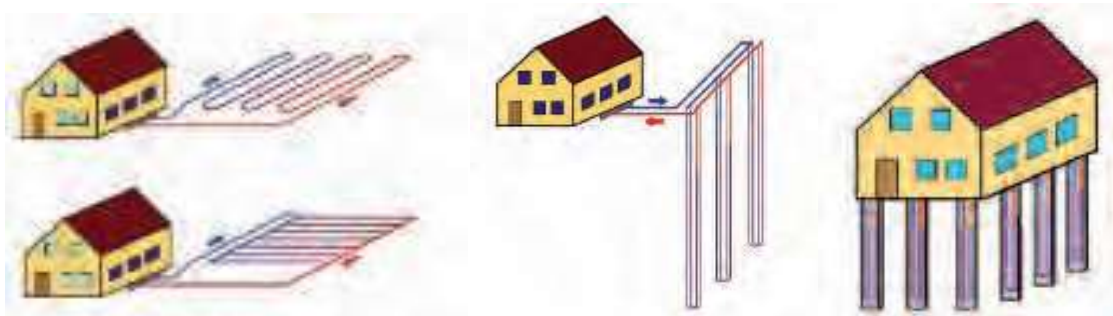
Captación Horizontal, Vertical, Pilotes Geotérmicos
